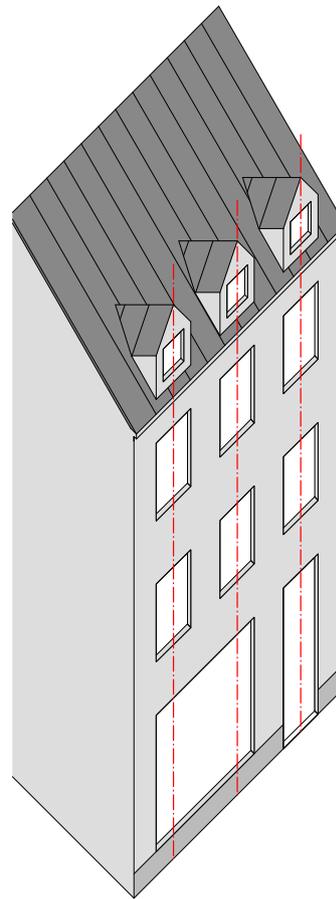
Das Fassadenraster im Erdgeschoss entspricht den Obergeschossen.
